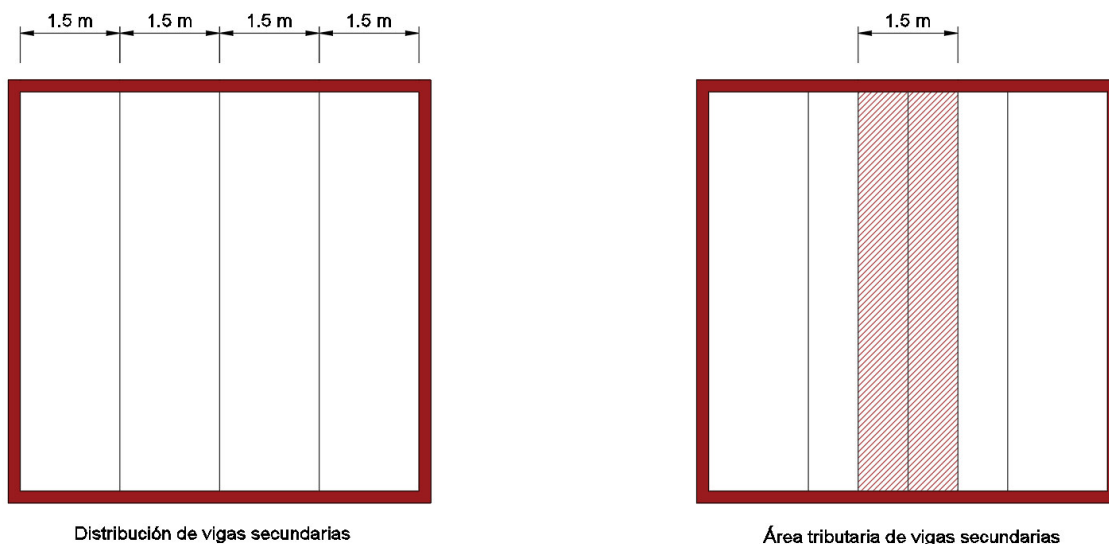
Distribución de vigas secundarias en tablero C-D – 1-2.
